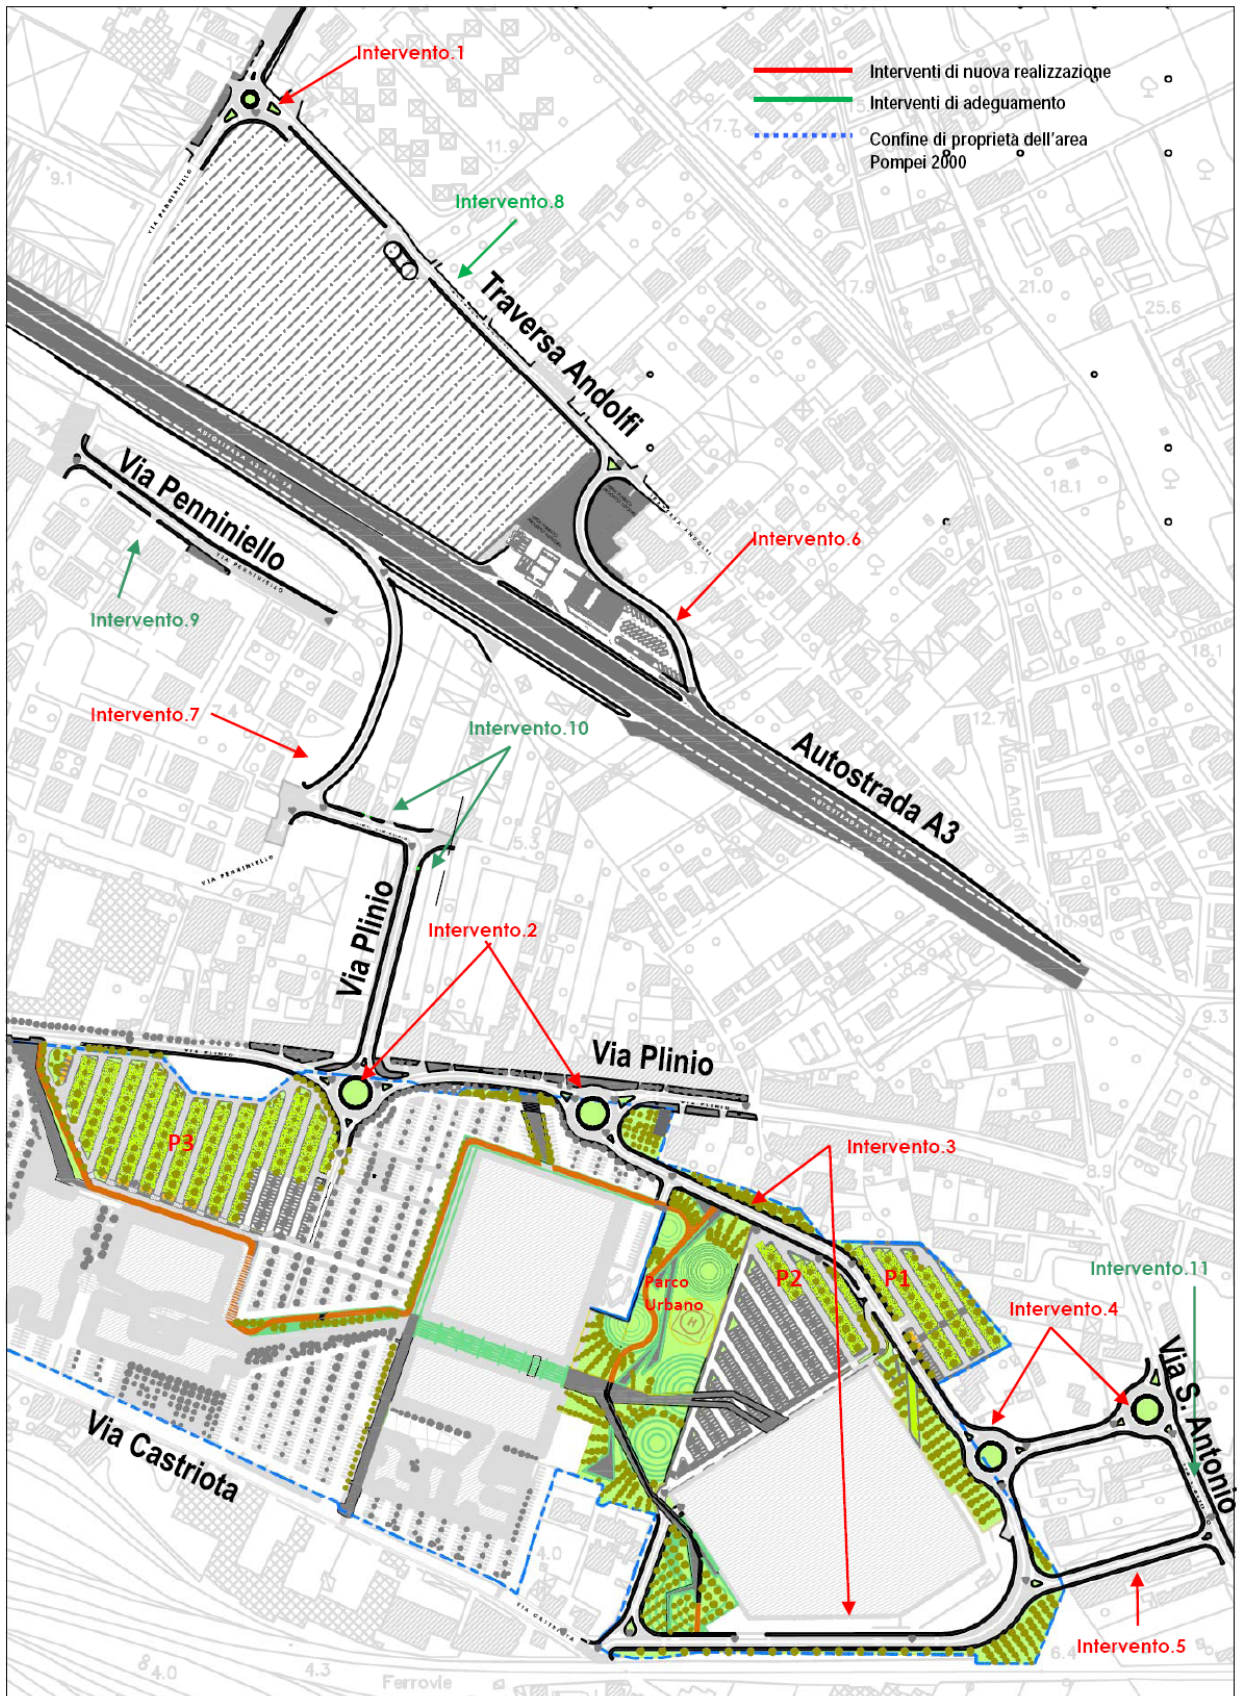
Interventi infrastrutturali (elaborazione su tavola VdTplm 017 del progetto definitivo viabilità e opere di urbanizzazione)
